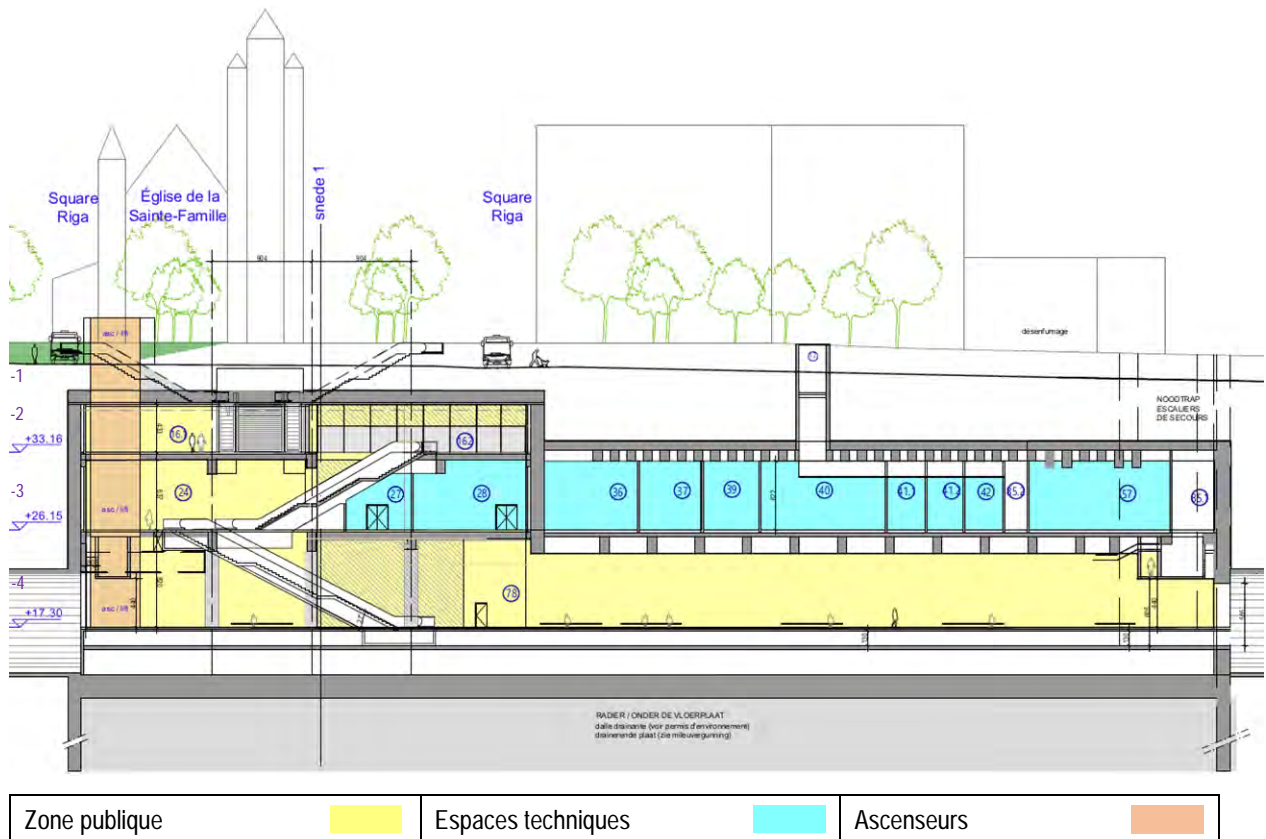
Station Riga, coupe longitudinale (BMN, 2018)
